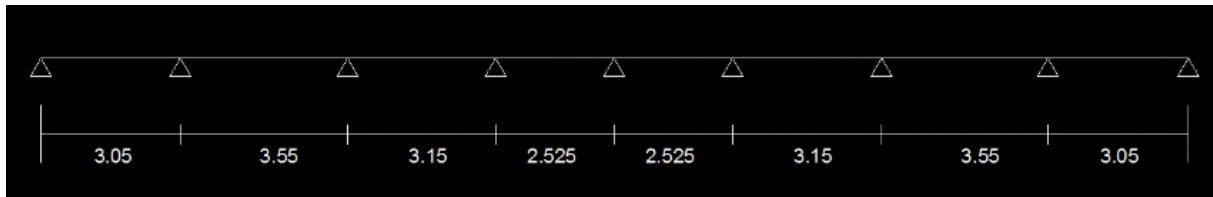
Schéma statique de la poutrelle simplement appuyé
